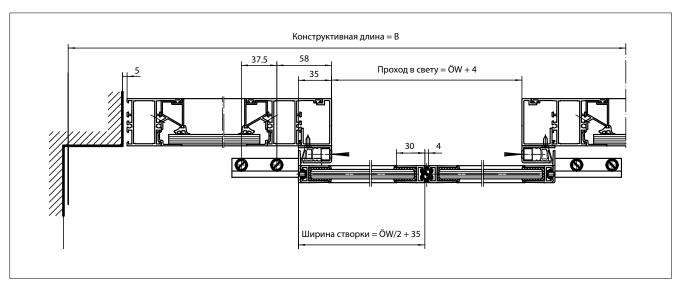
· Горизонтальное сечение одинарного безопасного стекла
